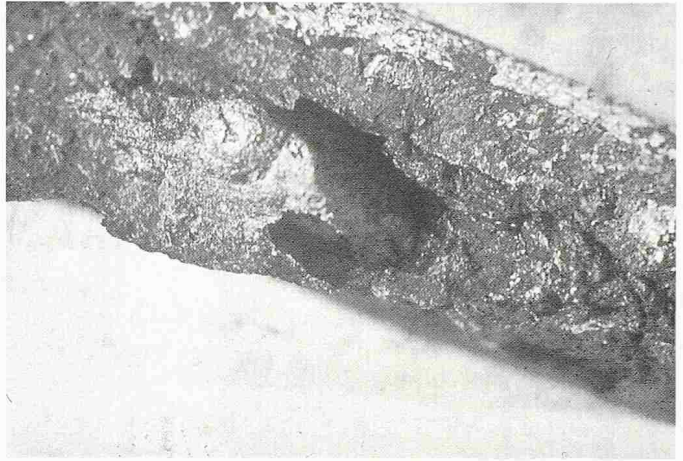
Typischer Frost/Tausalz-Schaden einer stark befahrenen Betonfahrbahn (Werkphoto SIKA AG)
